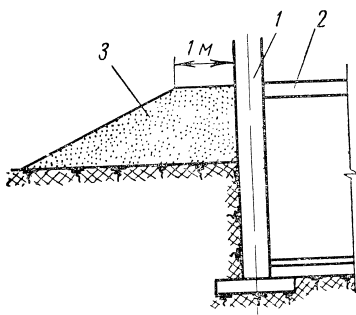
Обсыпка грунтом полуподвальных помещений:
